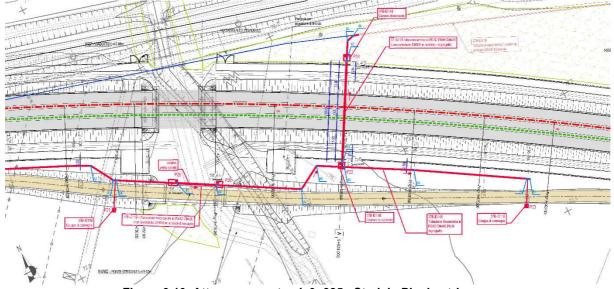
Attraversamento pk 9+825 - Stralcio Planimetrico
